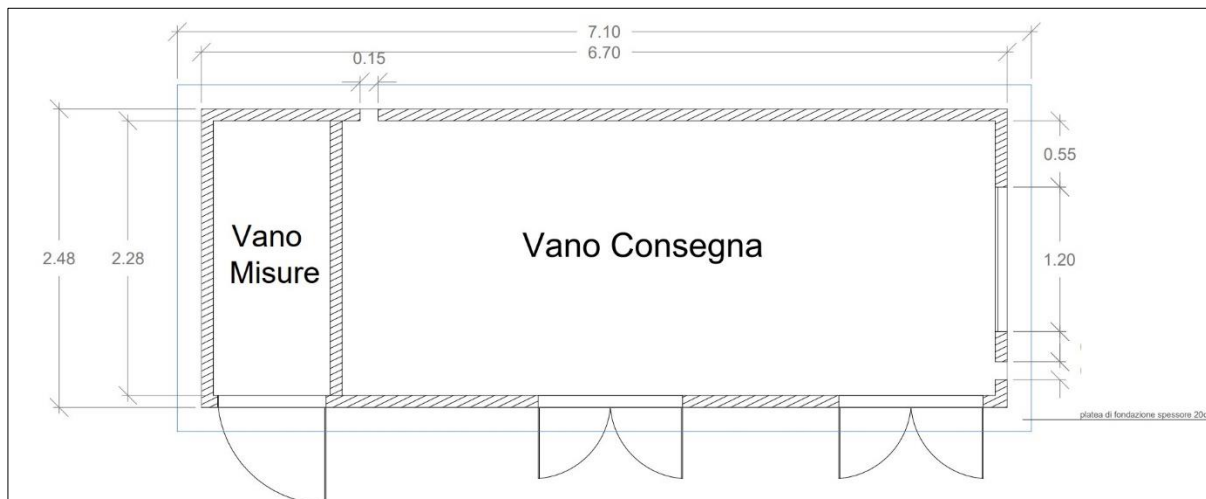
Pianta struttura di fondazione cabina utente di consegna
